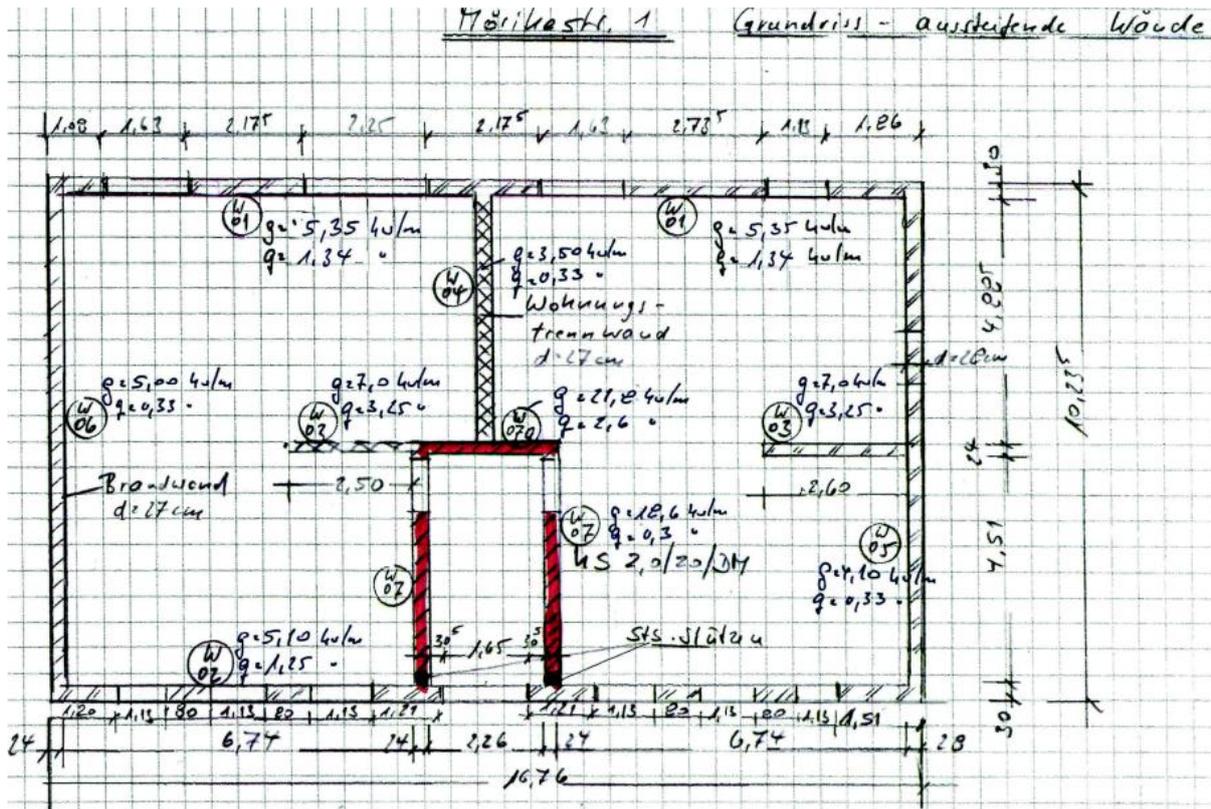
Grundriss der aussteifenden Wände, statische Berechnungen Cramer Engineering
